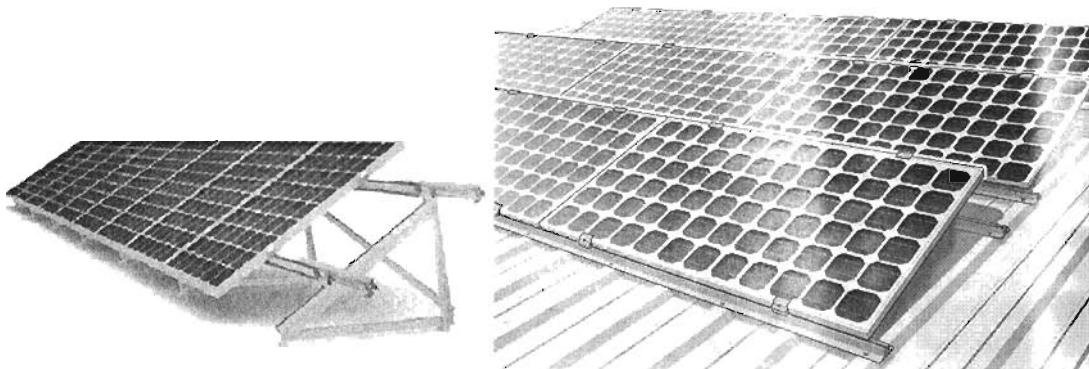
Exemplos de estruturas de suporte possíveis para o sistema BAPV.
